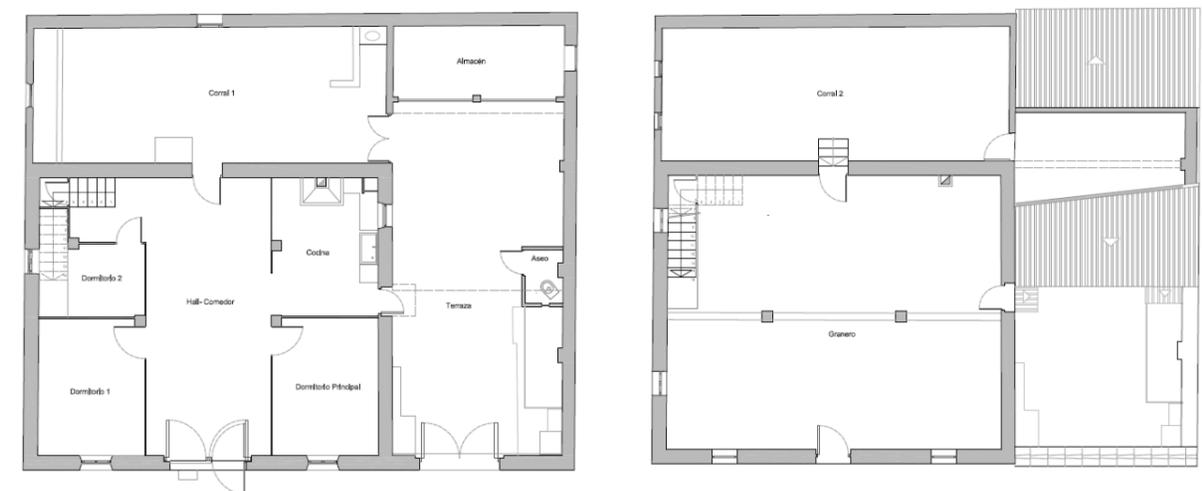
Tercera Fase Alquería Visquet. Planta Baja y Planta Primera. Fuente: autor propio
